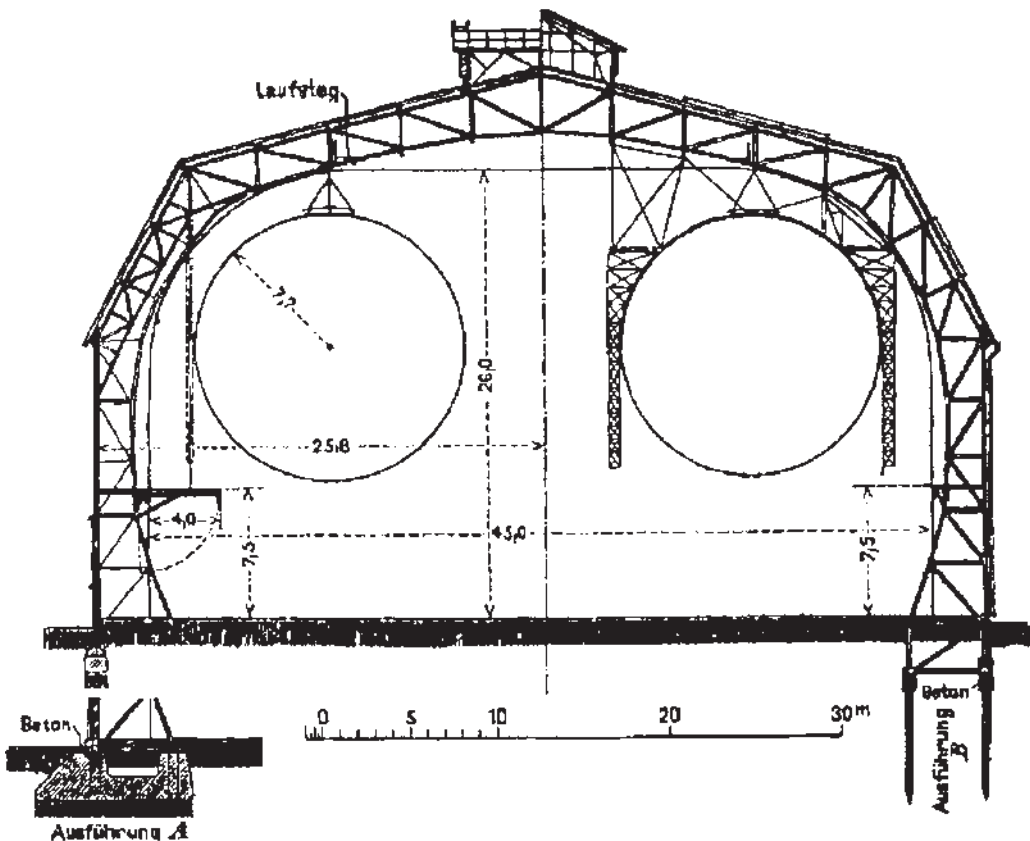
Luftschiffhalle Hamburg-Gr.Borstel [1.13]
